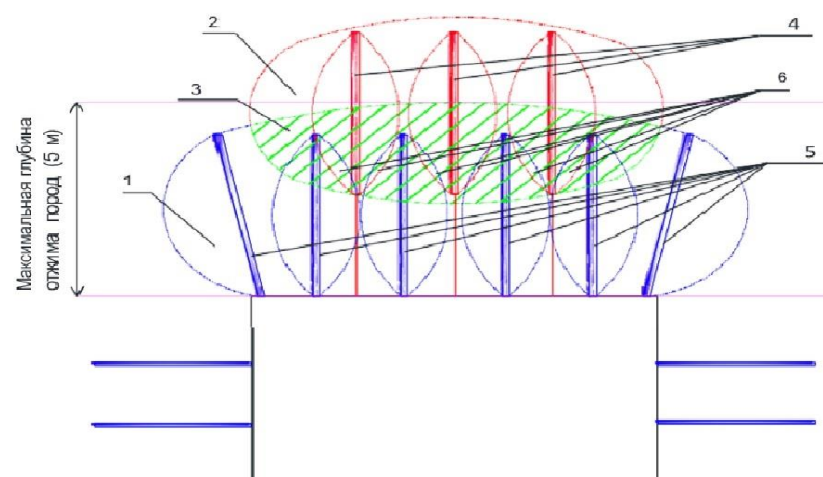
Схема двухуровневого крепления пород кровли выработки
